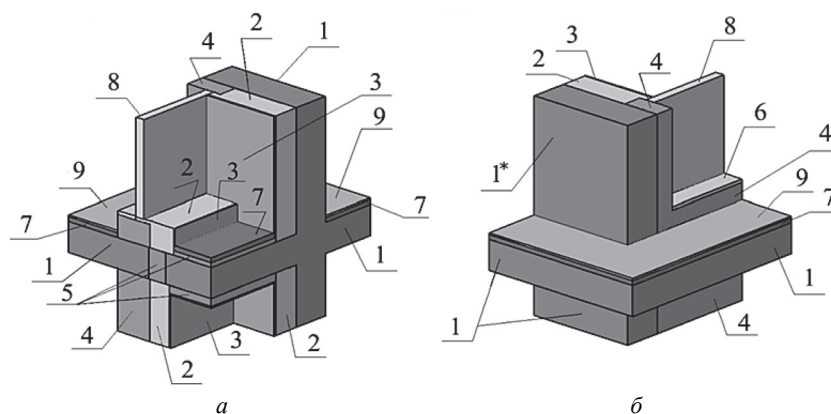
Геометрическая модель узла сопряжения междуэтажного перекрытия, колонны, участка самонесущей кладки, двери выхода на лоджию: *а* – вид со стороны лоджии; *б* – вид со стороны помещения; 1 – железобетон (несущий каркас); 2 – минераловатная плита; 3 – защитная штукатурка; 4 – вкладыши из пенополистирола; 5 – теплоизоляционный вкладыш; 6 – теплоизоляционный вкладыш; 7 – цементно-песчаная стяжка; 8 – заполнение светового проёма (дверь на лоджию); 9 – покрытие пола
